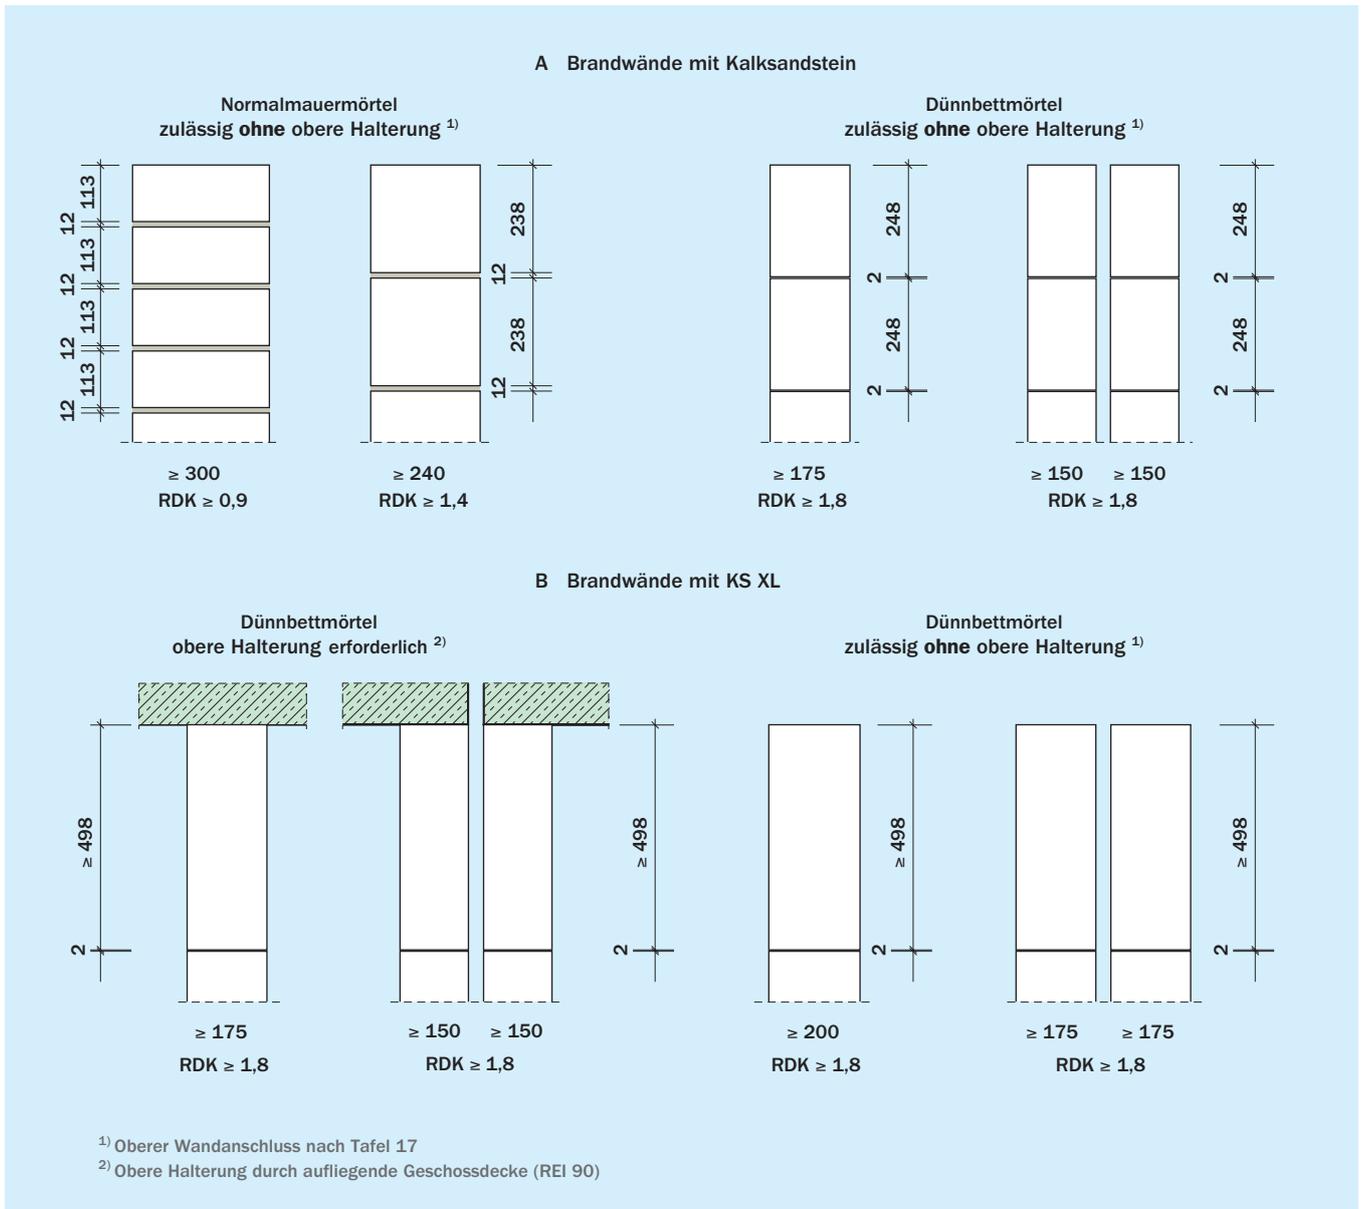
Halterungen von Brandwänden aus KS-Mauerwerk
